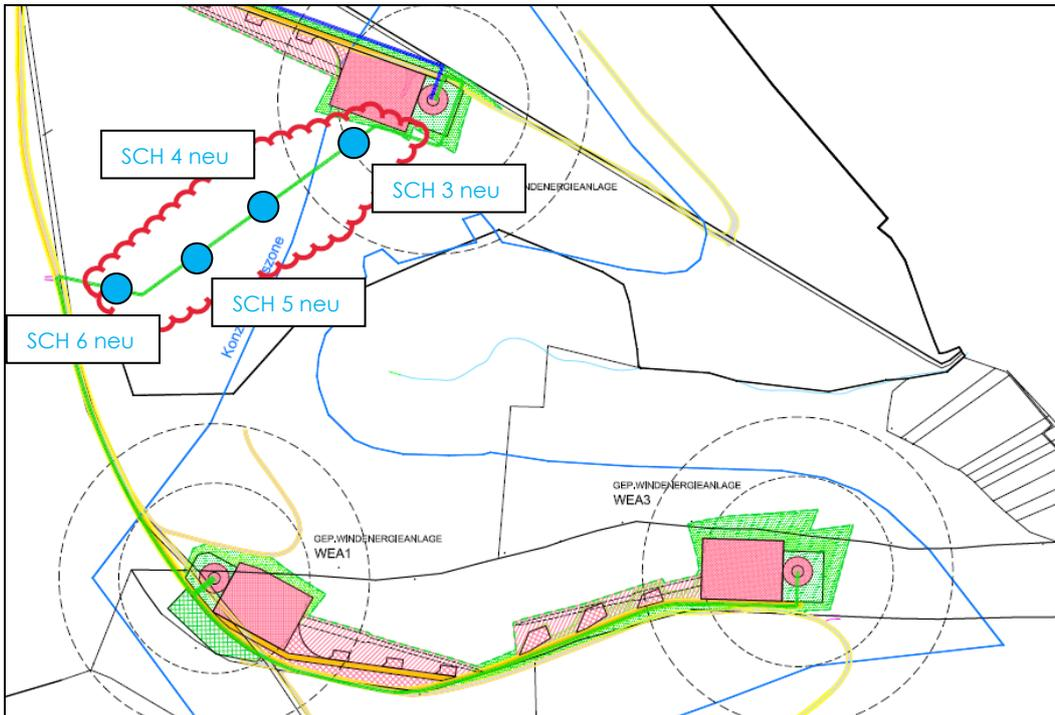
Auszug Lageplan (aus (1)) mit Lage der Aufschlusspunkte (blau markiert)
